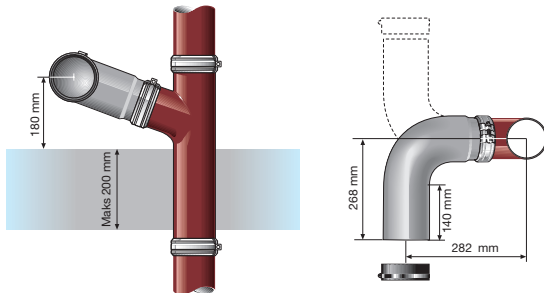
Tilkobling av ett eller to klosetter med P-lås til side for vertikal samleledning, plan.
